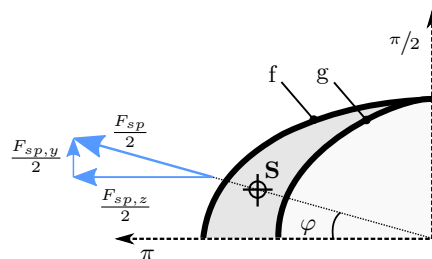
Neigung der resultierenden Betondruckstrebe quer zur Längsachse
